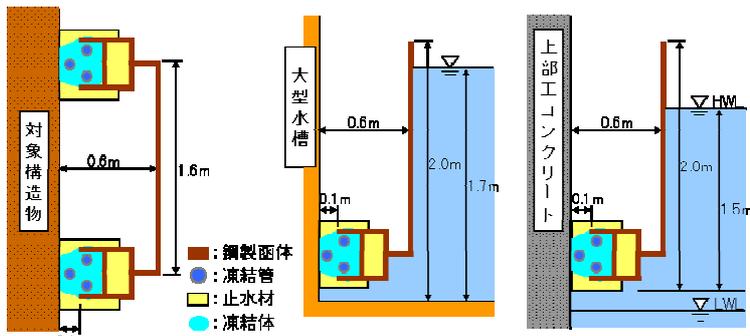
(左)鋼製函体平面図 (中)大型水槽実験断面図 (右)実海洋環境実験断面図
